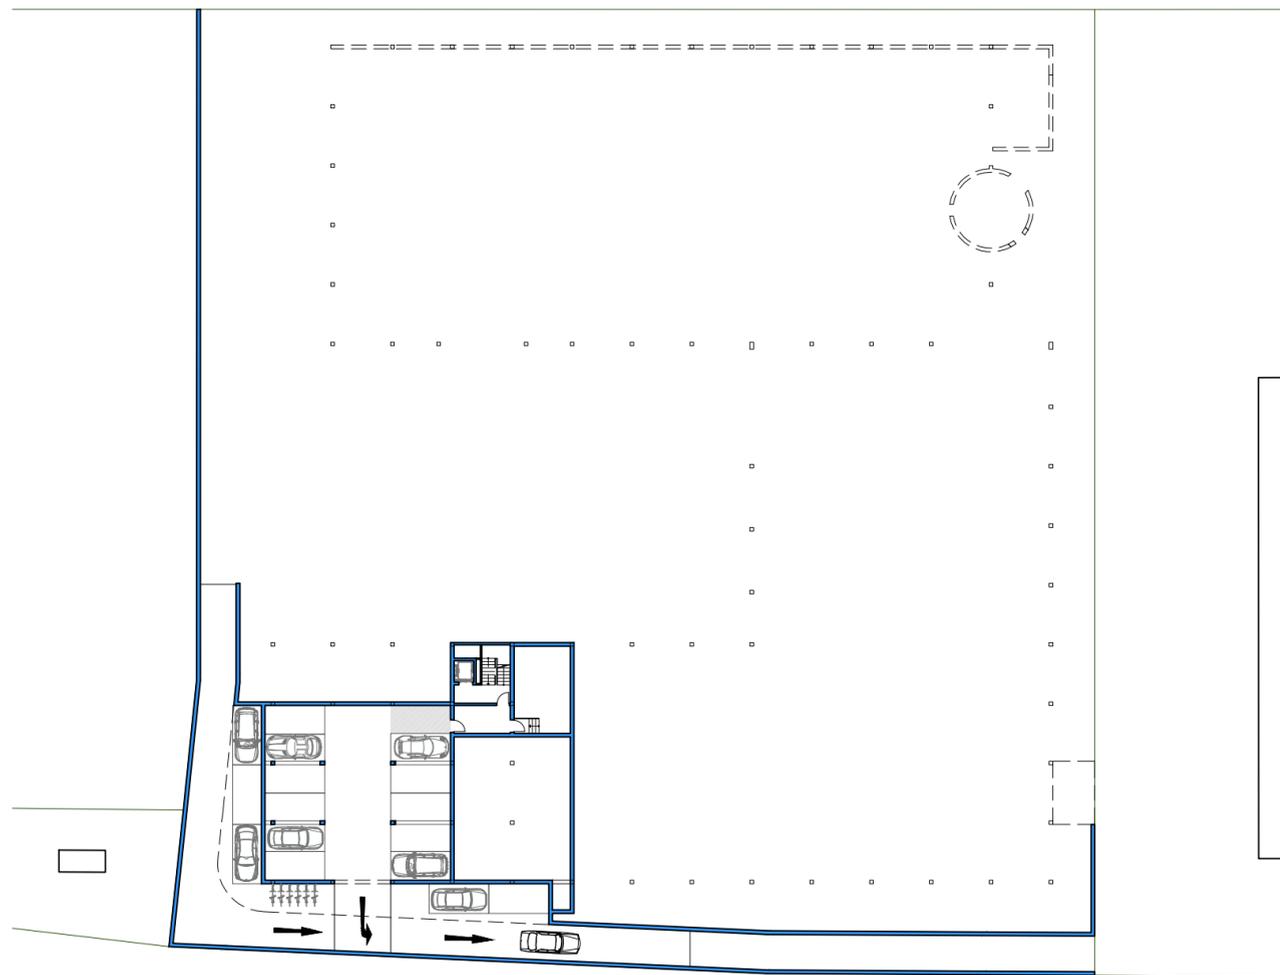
Vorentwurf II - Grundriss Kellergeschoß
